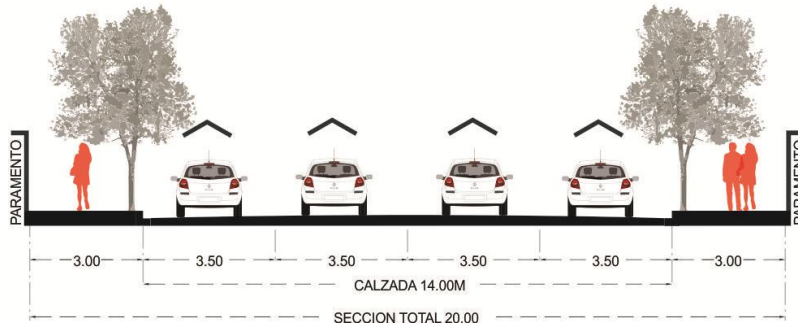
Sección Vialidad Primeria 20m.
